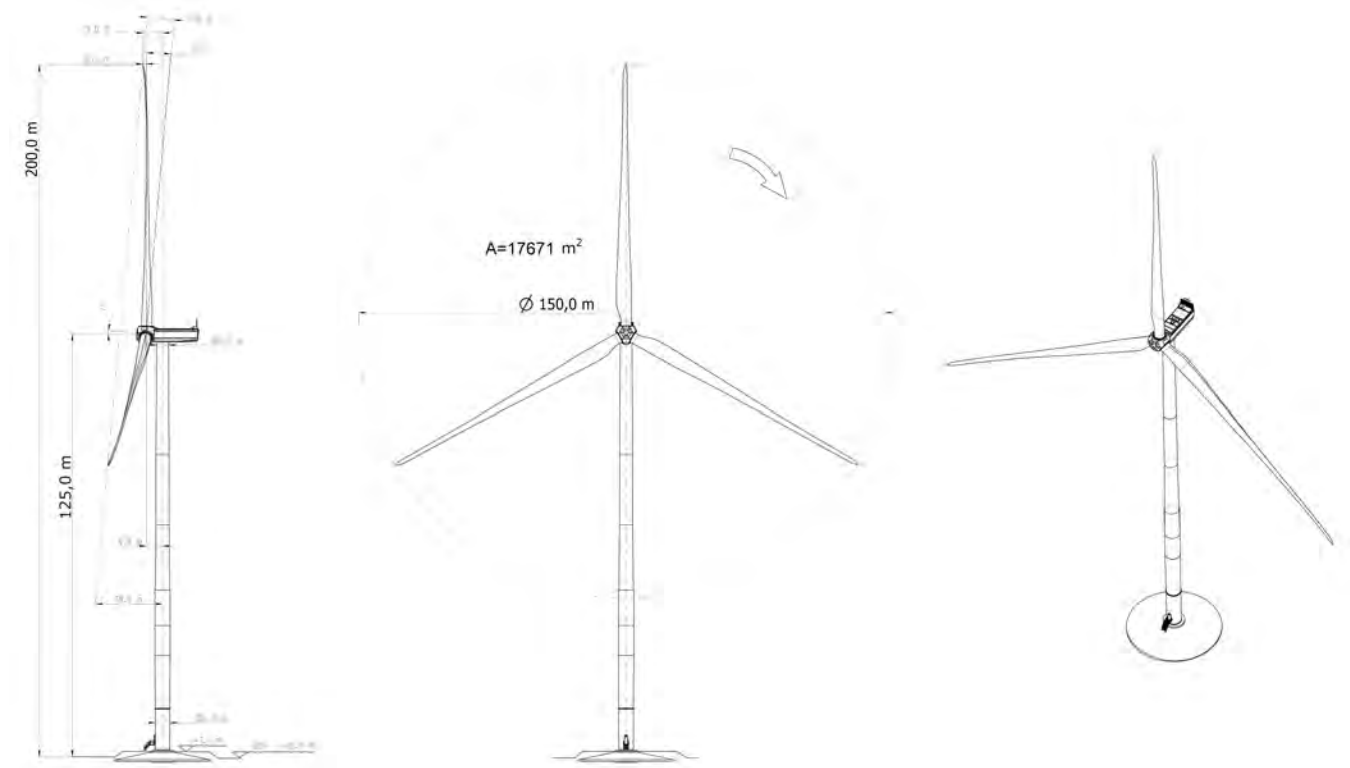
Exemple de plans d'une éolienne-type et dimensions
